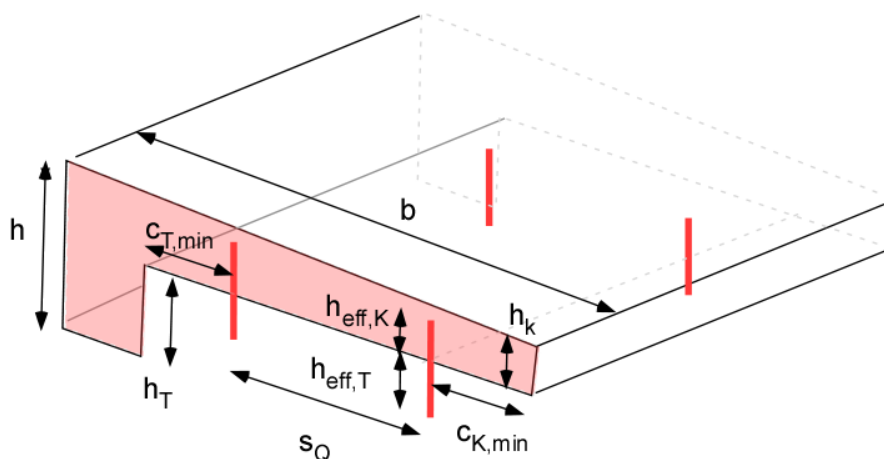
Berechnungsrelevante Abmessungen.
